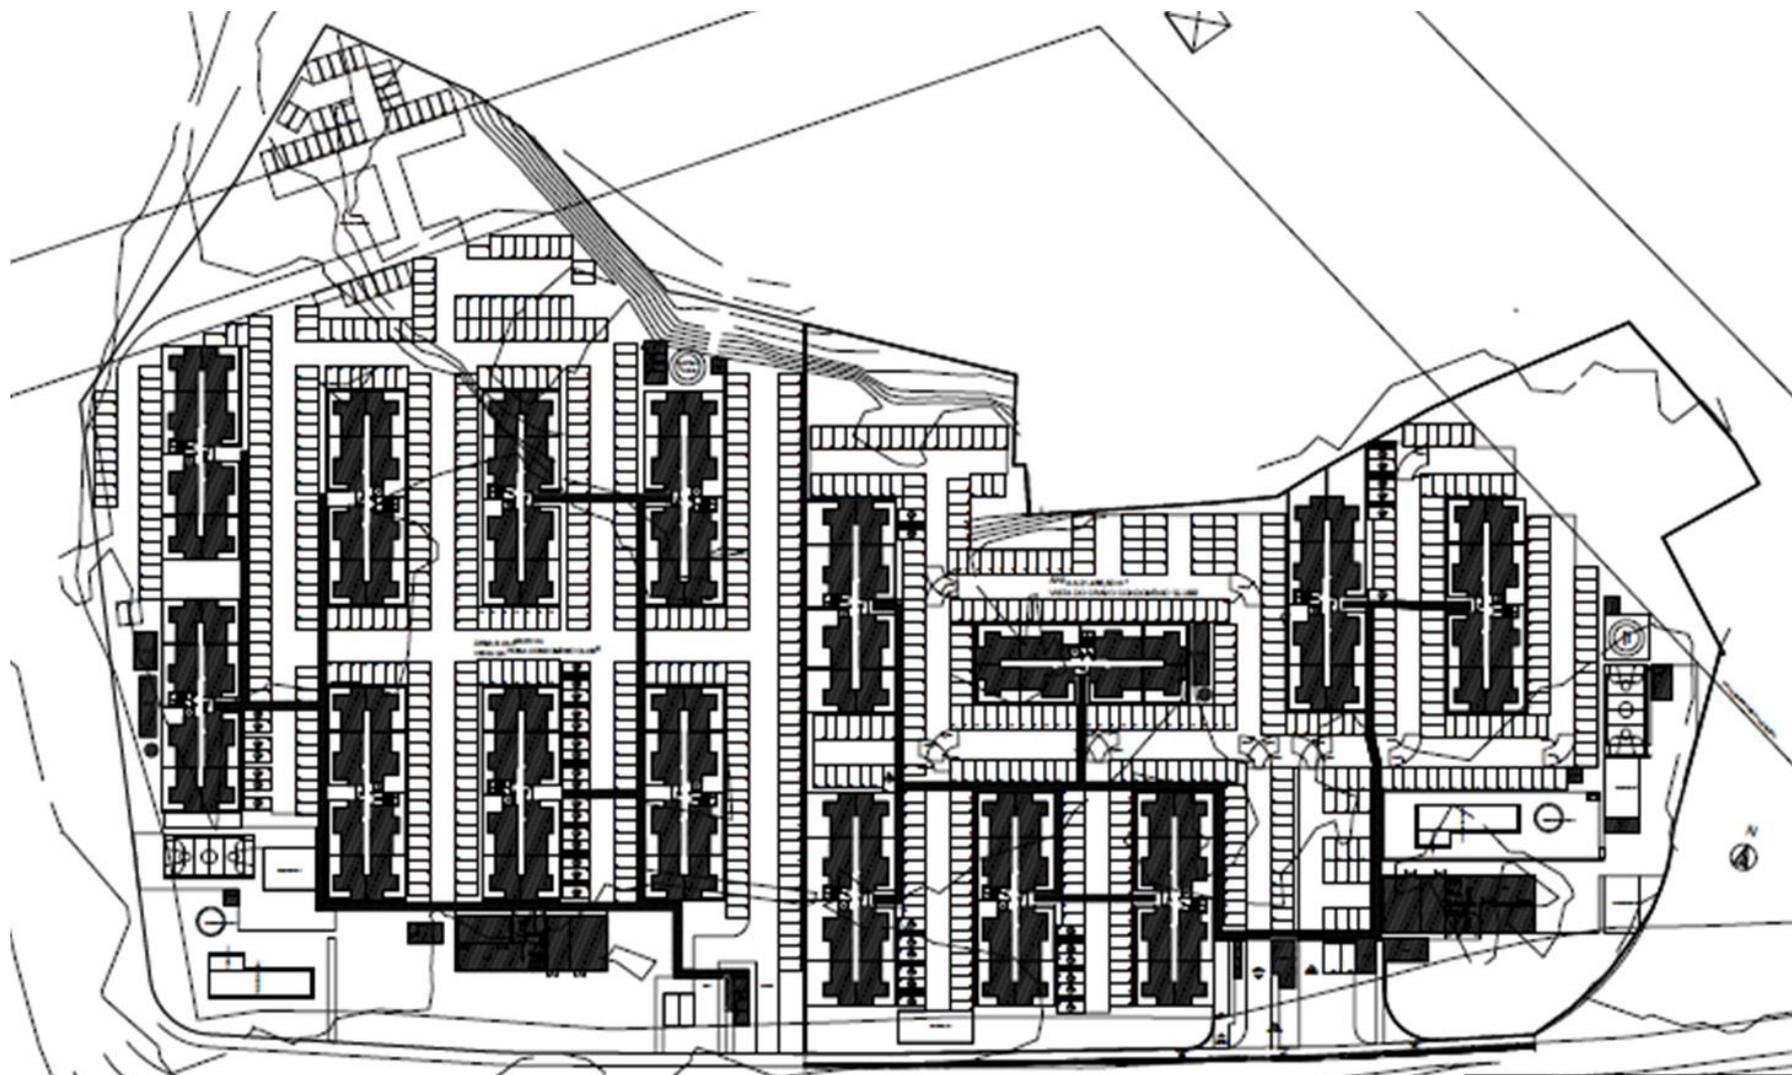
Implantação geral – Condomínios Vista do Cravo e Vista da Rosa.
